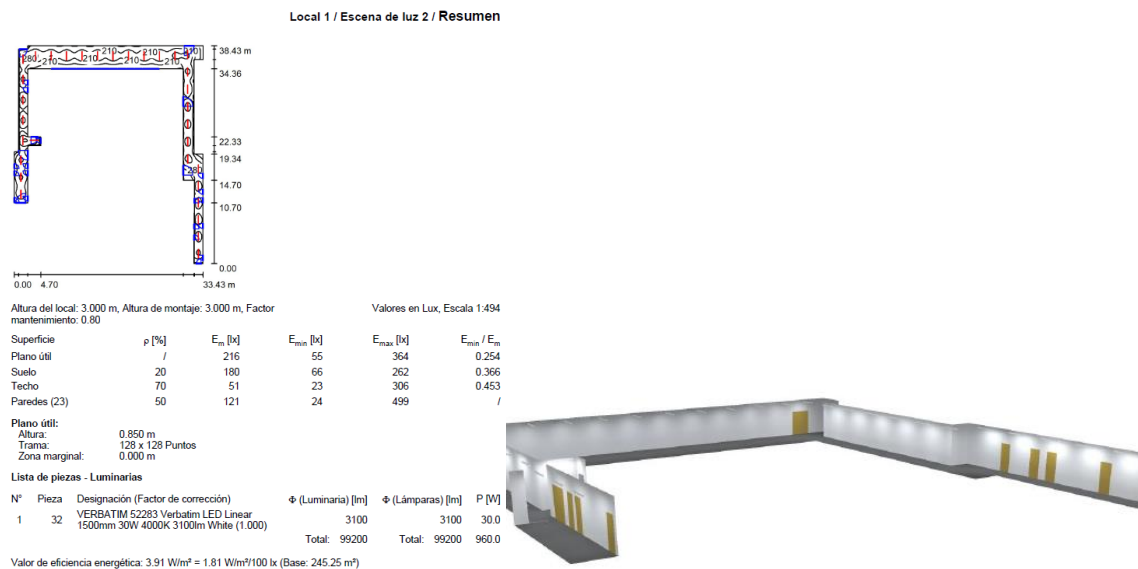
Diseño de iluminación propuesto para corredor en la Planta 8.
